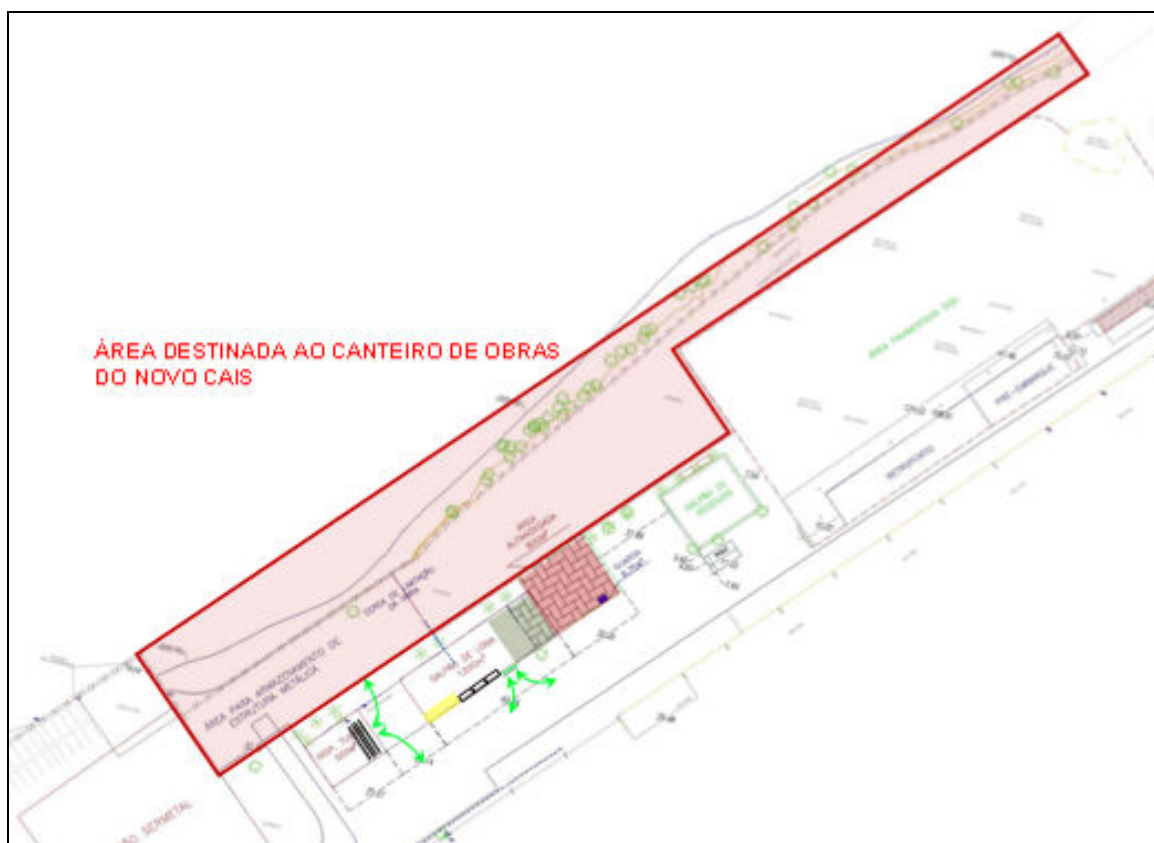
Área do Terminal Briclog destinada ao canteiro de obras (Fonte: Briclog).
